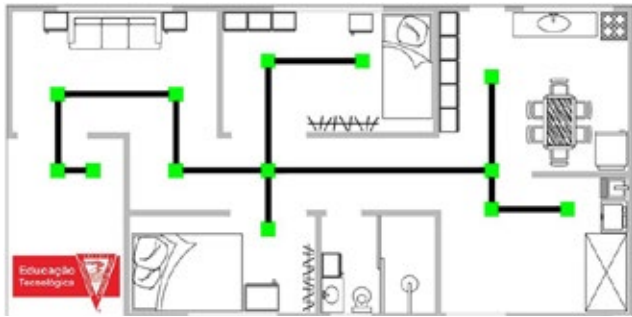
Planta baixa utilizada no projeto. Adaptado de <https://andrealasserre.files.wordpress.com/2008/07/planta-baixa.jpg>, 2015
